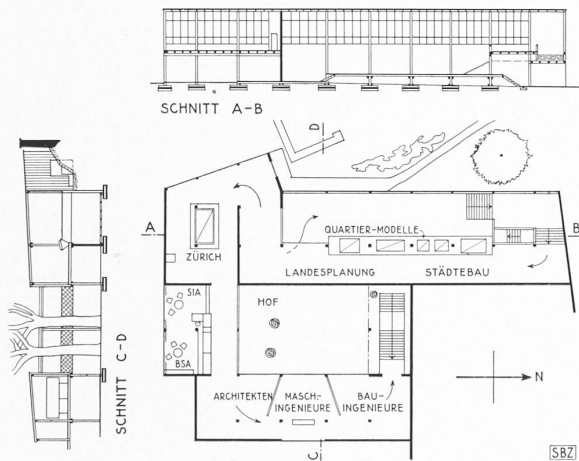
Ausstellung «Plan und Bau», I. Stock und Schnitte 1 : 800
